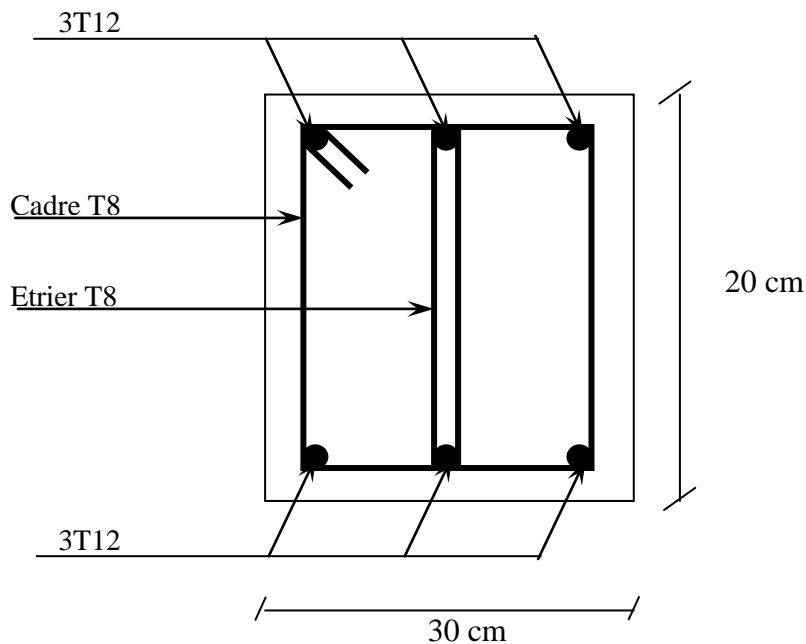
Schéma de ferrailage de la poutre de chaînage
